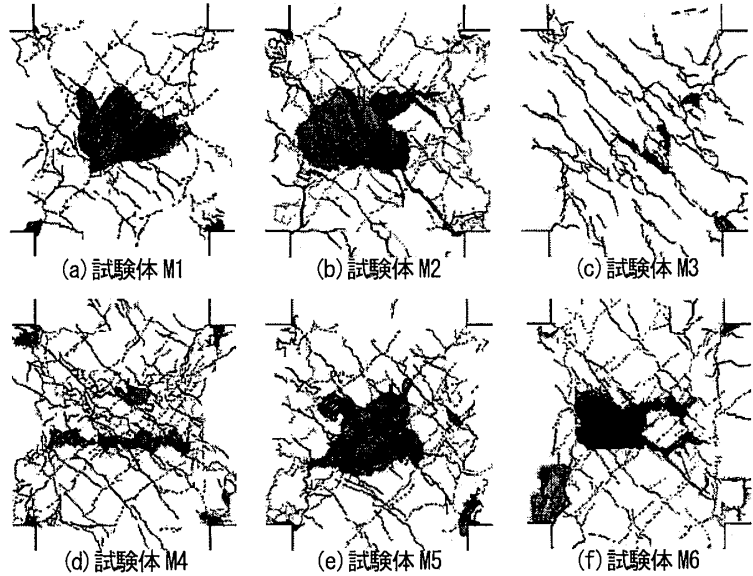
ひび割れ状況 (層間変形 $\theta=1/25\text{rad.}$)
